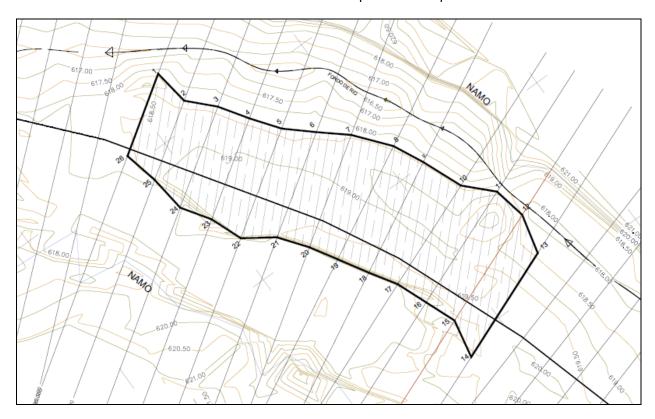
Detalle de plano en planta del polígono de extracción (color verde)
